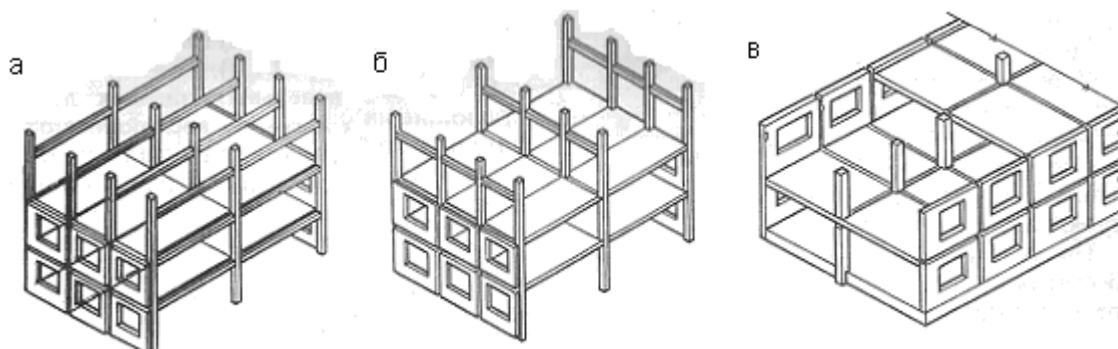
Конструктивные схемы каркасно-панельных зданий
